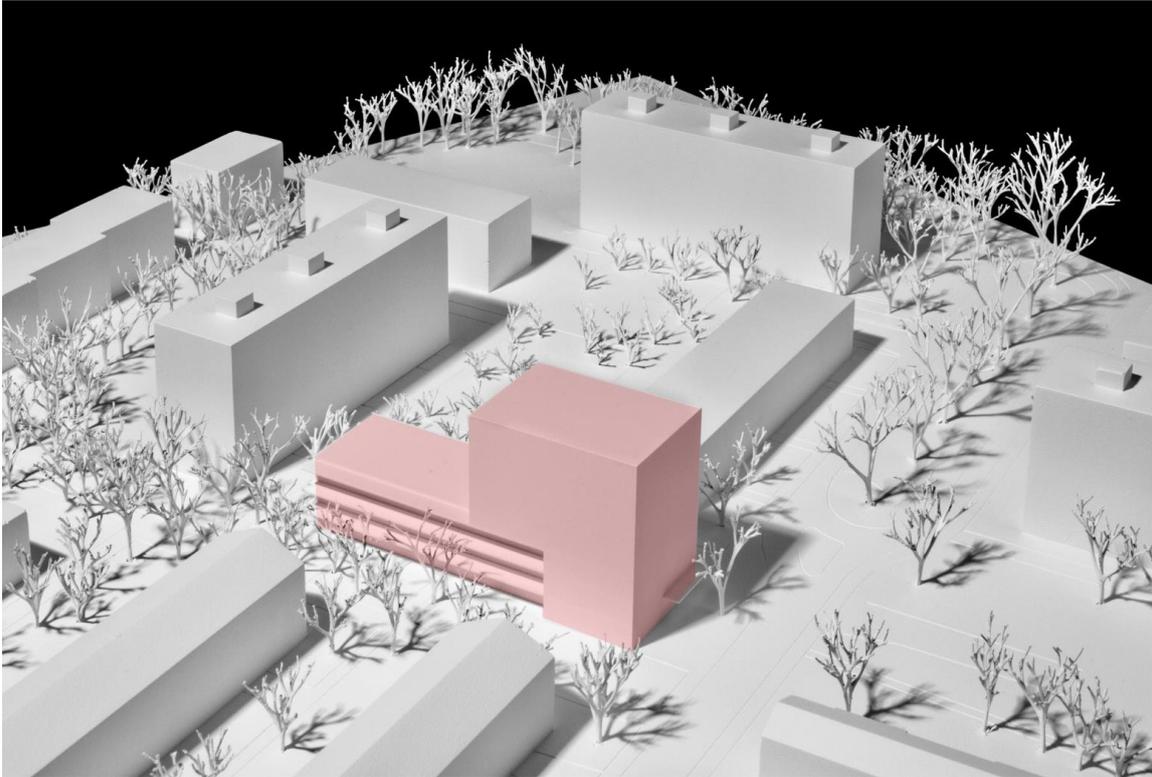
Das Areal der BWG Nünenen mit 3- bis 4-geschossigen sowie 8-geschossigen Bestandesbauten und mit dem 3- bzw. 8-geschossigen Ersatzneubau (rot hinterlegt).
